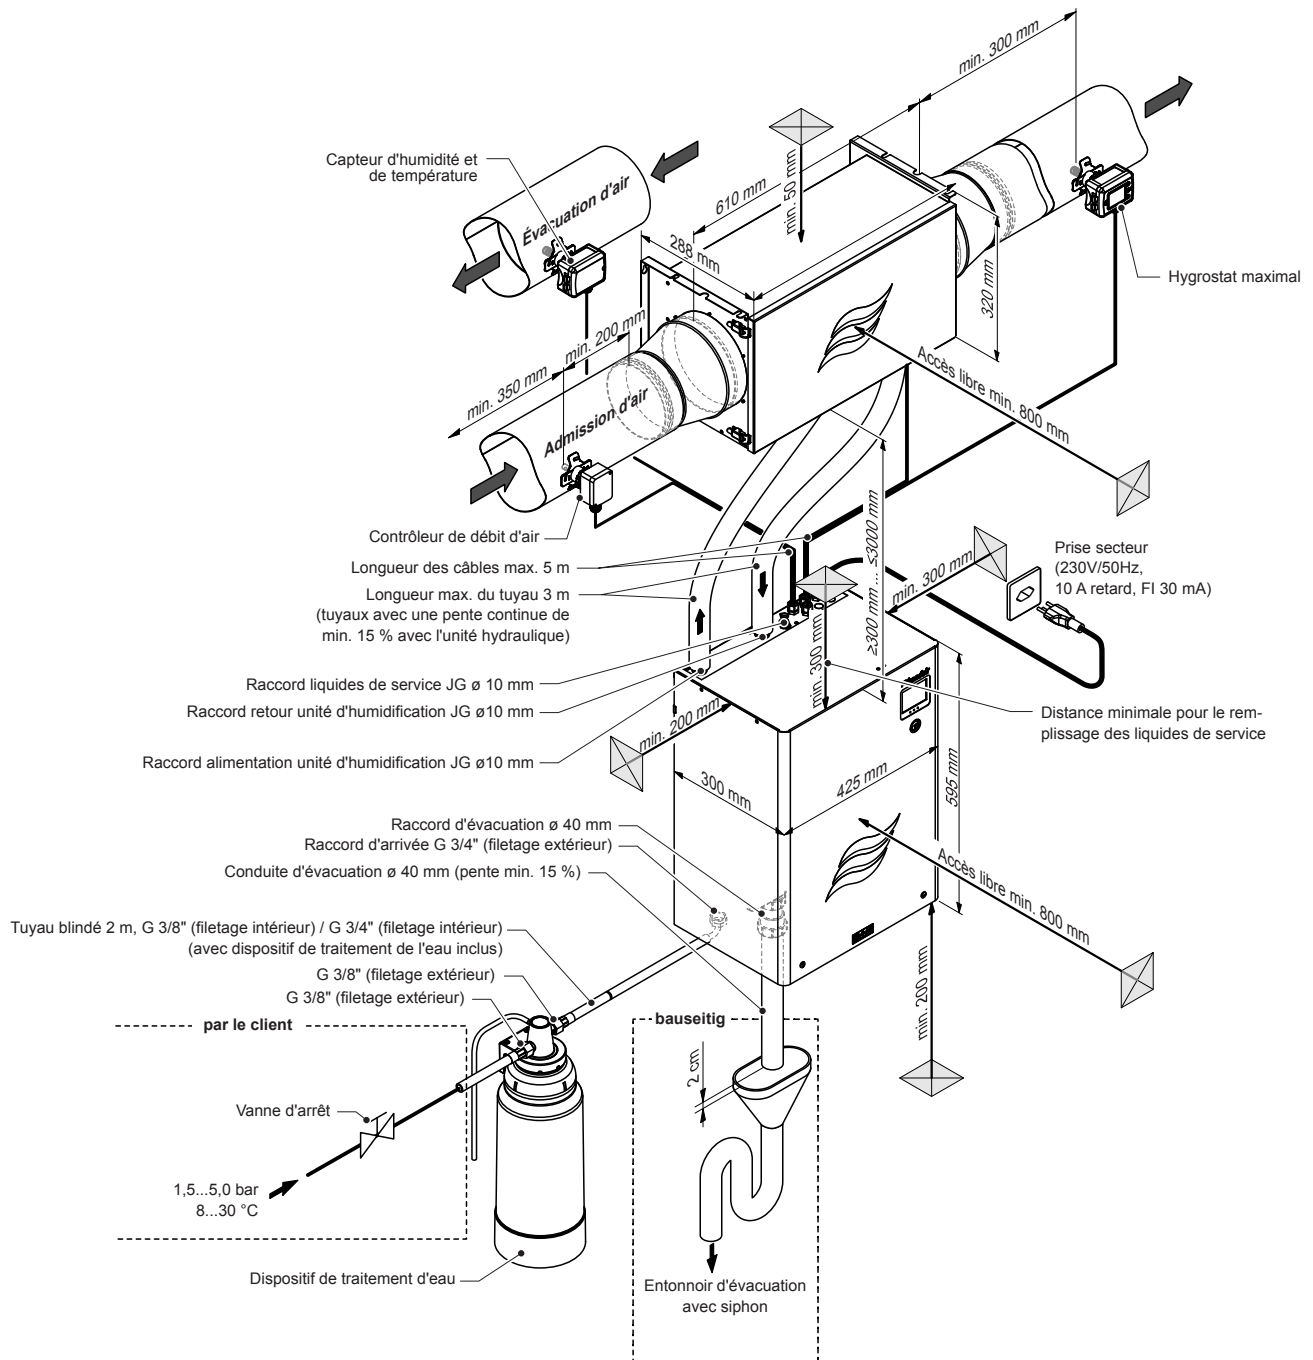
Aperçu de l'installation du Condair MD, variante MD-EL-H
